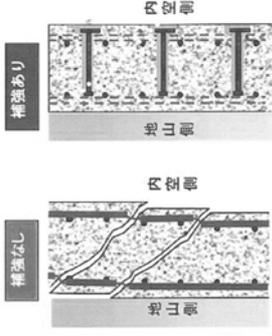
鉄筋コンクリート増打ち工法の施工例
